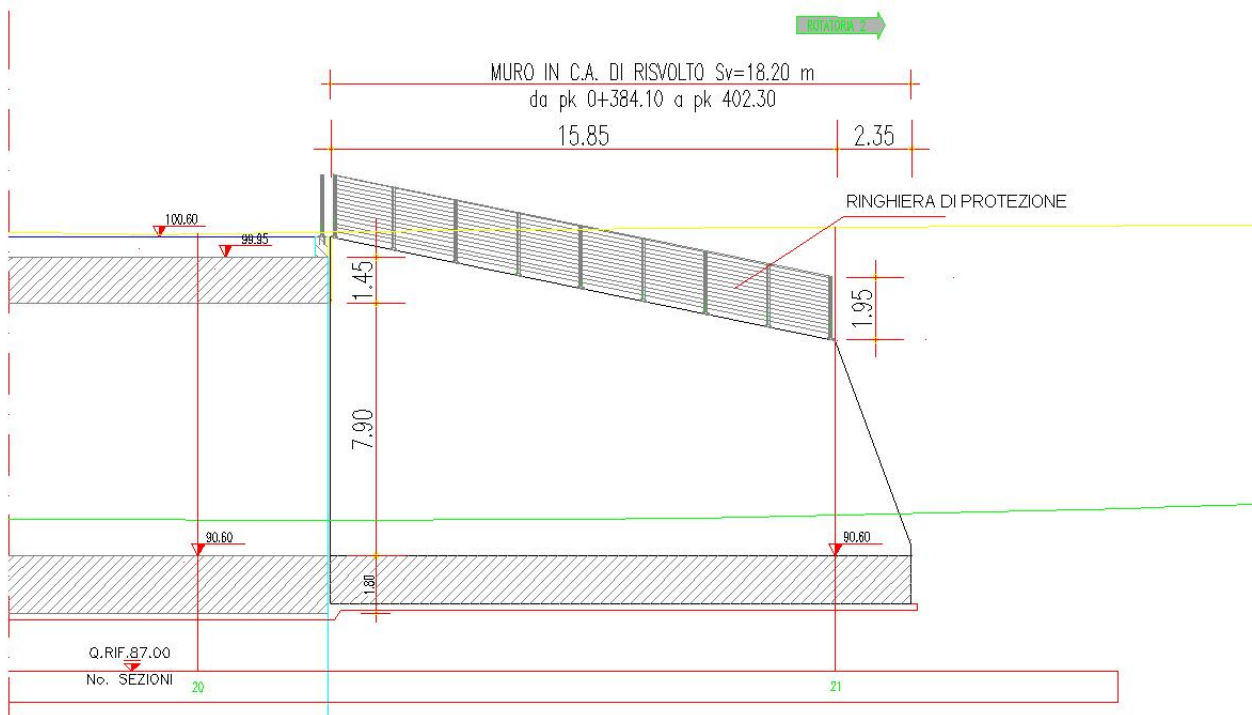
Prospetto muro di risvolto da pk 0+384.10.00 a pk 0+402.30 con ringhiera di protezione
